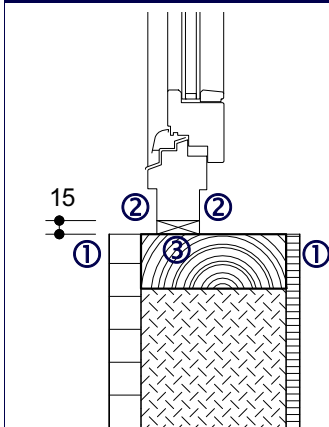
Bei der Herstellung des Rohbaus werden die Außen- und Innenbekleidungen bündig ausgeführt ①. Das Fenster ist innen und außen mit einem Falz ② ausgestattet. Beim Einbau werden unterhalb der vertikalen Rahmenhölzer Auflagerklötze ③ positioniert, um die Eigenlasten des Fensters in die Rohbauwand sicher abzuleiten.
